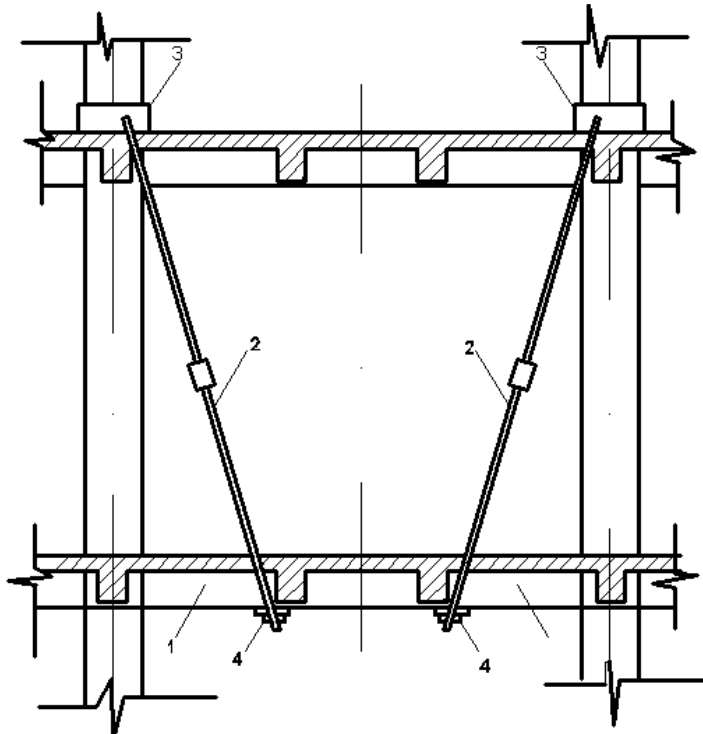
Підсилювання додатковою пружною опорою: 1 – підсилюване перекриття; 2 – тяги; 3, 4 – кріплення тяги.
